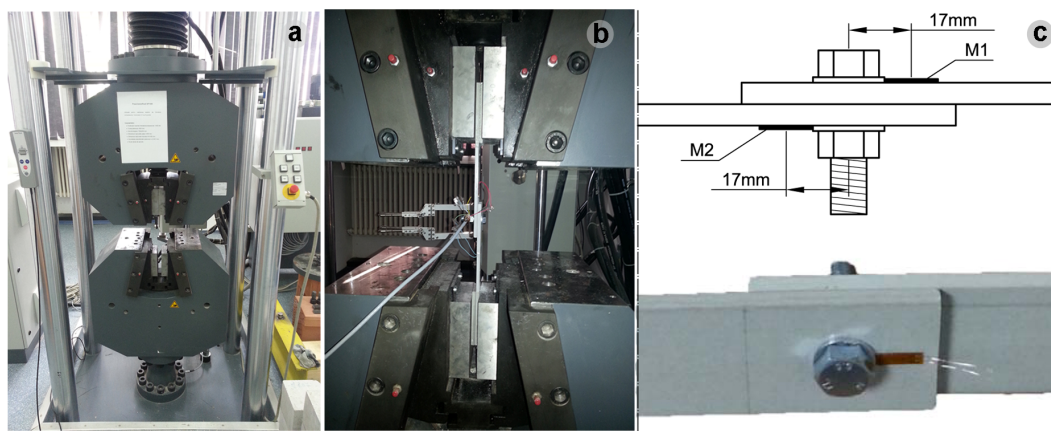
Instrumentarea și testarea epruvetelor / Specimens instrumentation and testing: a) mașină universală de încercat / Universal Testing Machine (UTM); b) poziționarea probei în bacurile presei / specimen positioning in the UTM grips; c) instrumentarea probelor cu mărci tensometrice / specimens instrumentation with strain gauges.
